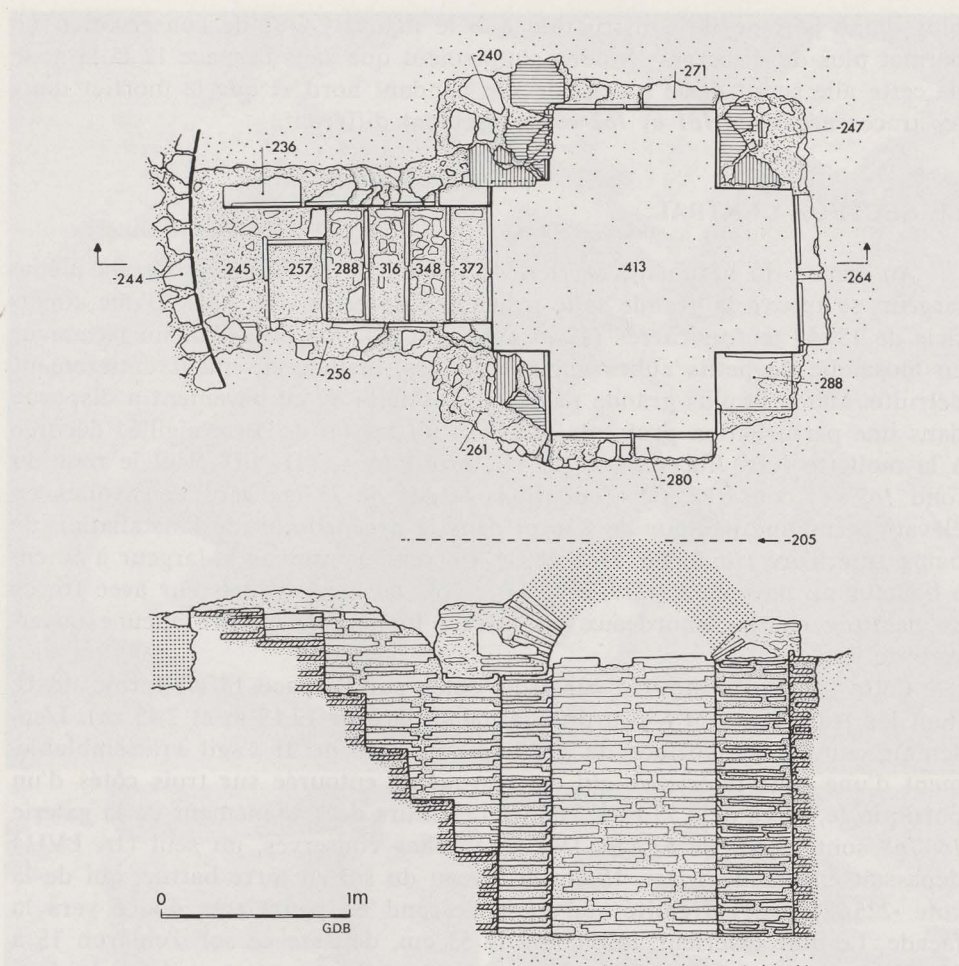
Plan et coupe de la cave 153 (Ech. 1/40^e).
